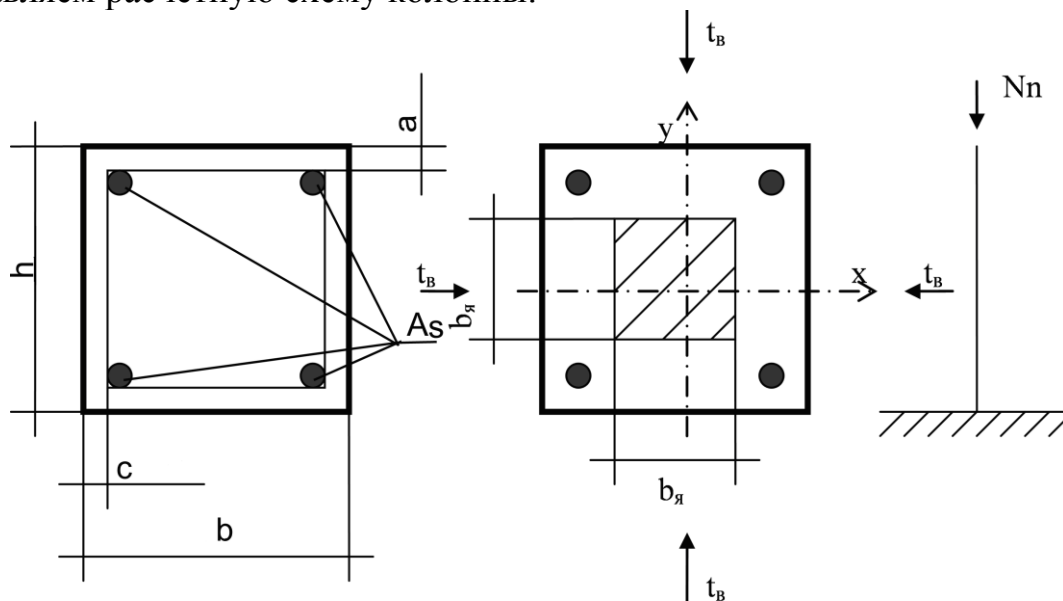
Расчетная схема железобетонной колонны: h – длина колонны; N_p – нормативная нагрузка, кН; b – ширина колонны; $b_я$ – ширина ядра сечения колонны; A_s – суммарное сечение арматуры; a, c – толщина защитного слоя бетона в разных участках колонны
